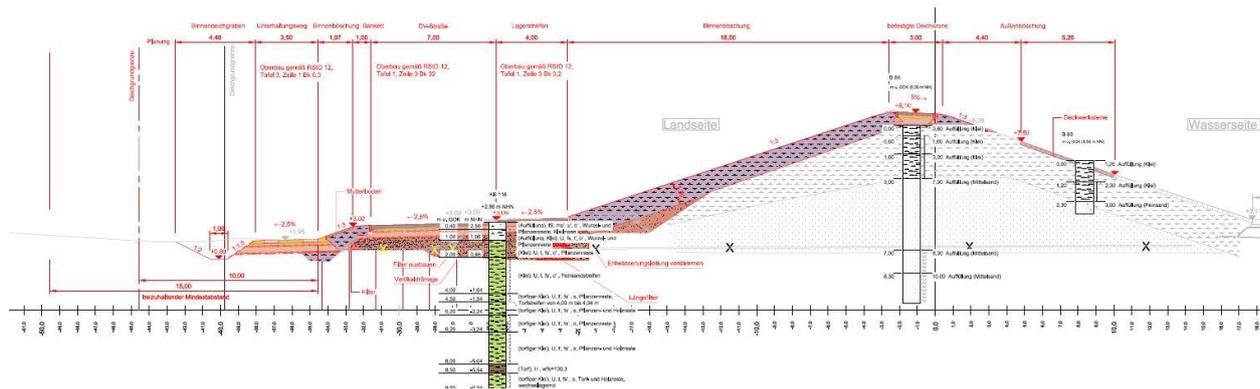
Exemplarischer Regelquerschnitt (Planung) mit Baugrunderdarstellung am Cranzer Hauptdeich (s. Zeichnung PFU 02_C_4.10)
